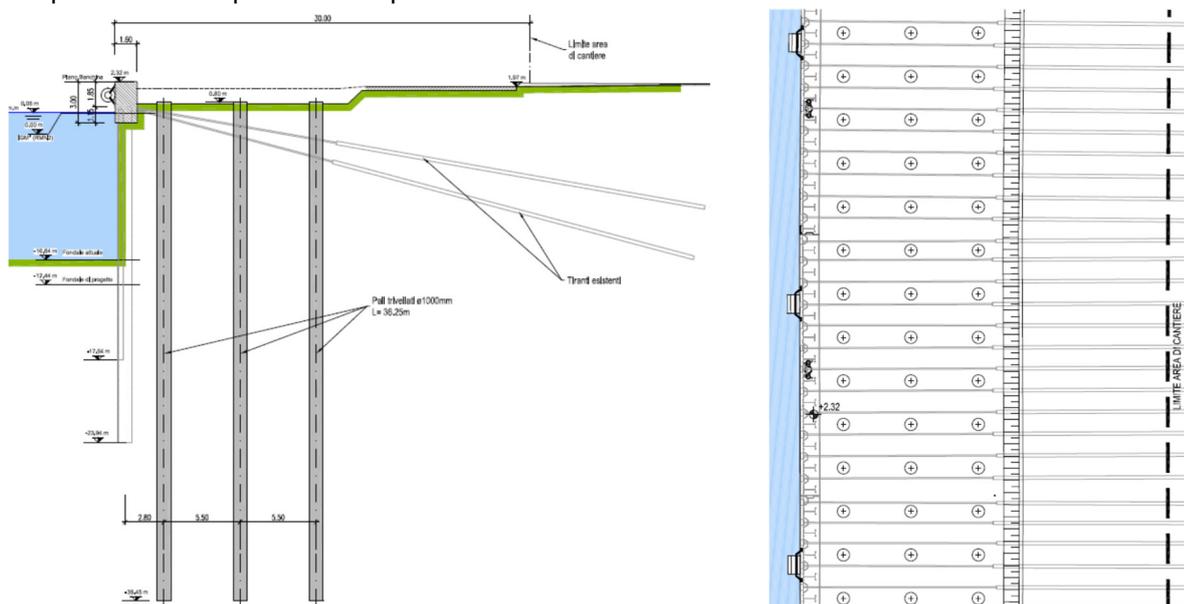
Banchina Trattaroli Nord – Fase 5 – Sezione e planimetria
